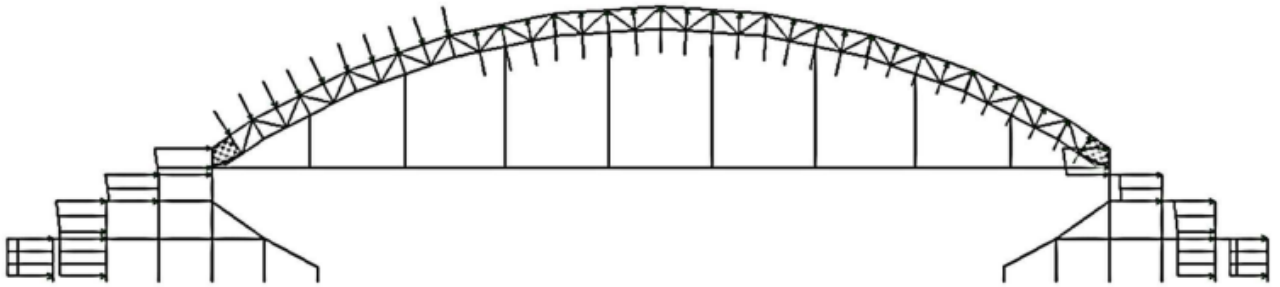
Завантаження вітровим навантаженням поперек будівлі X+
